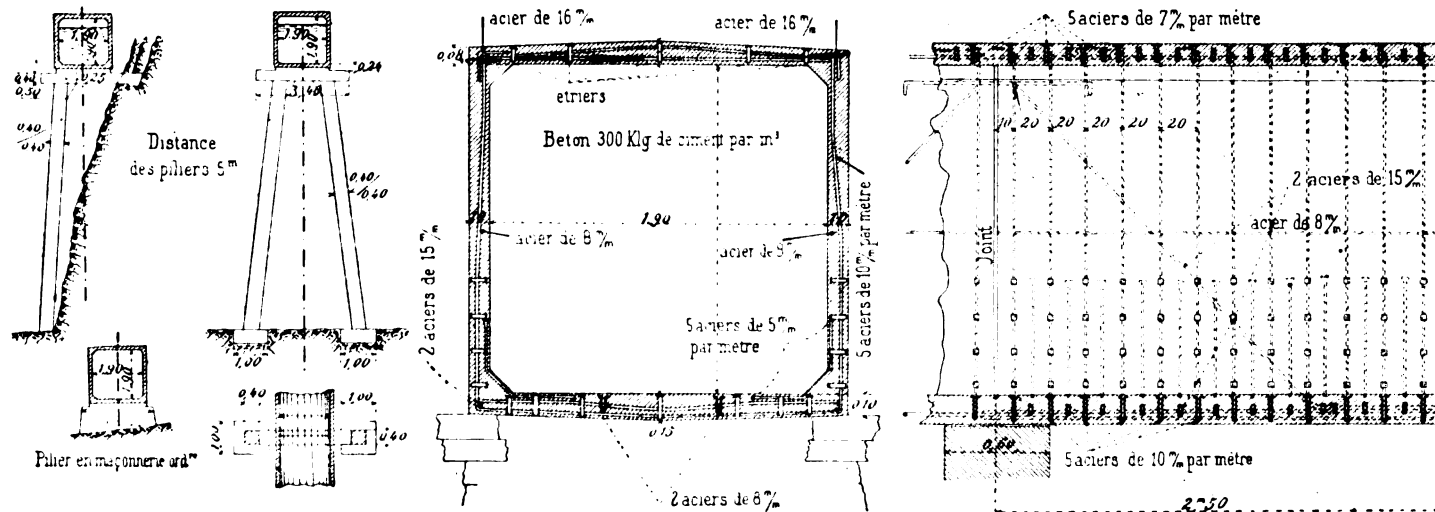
à 19. — Profils en travers, plan et coupe longitudinale du canal en béton armé du canal d'amenée de l'usine de Brigue.
